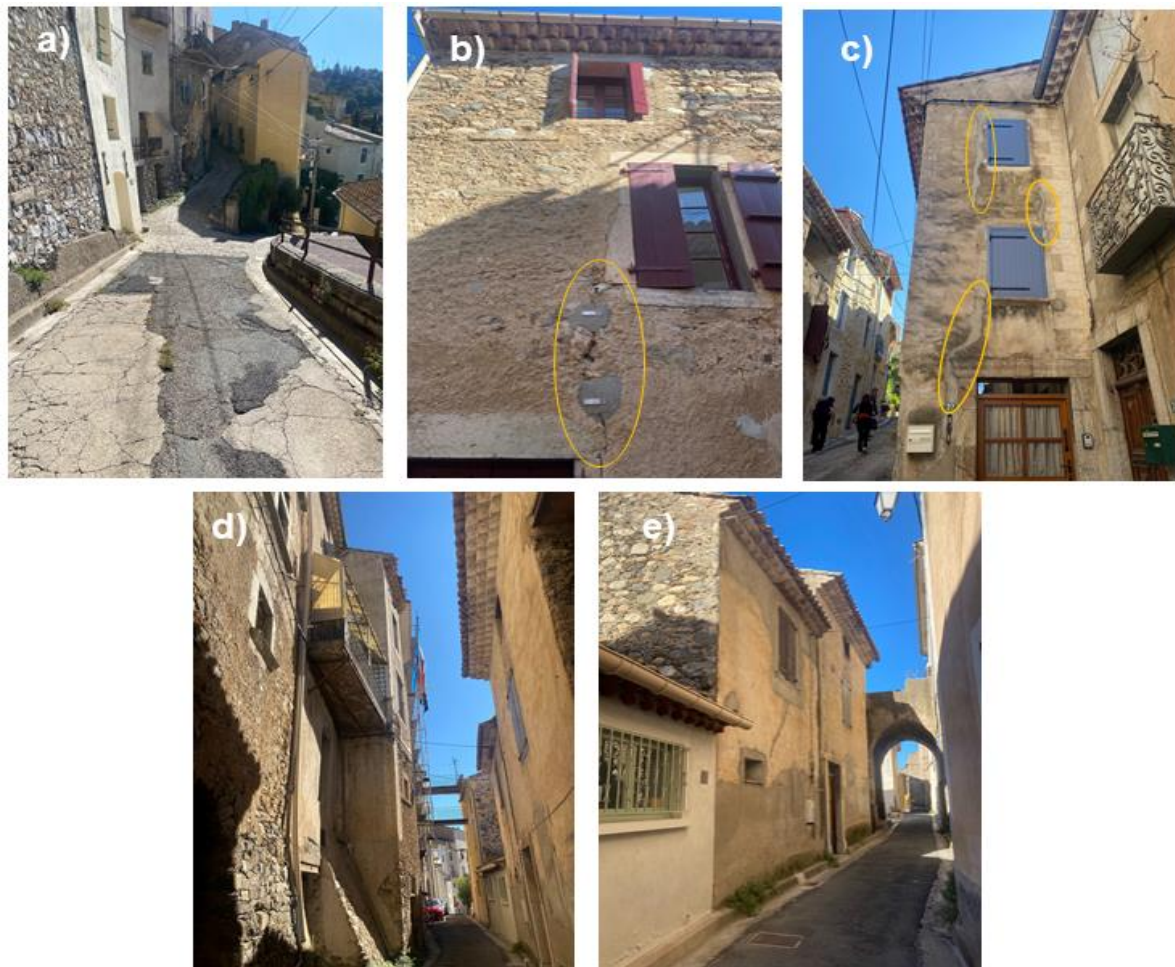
a) chaussée fissurée de la rue sous les fenêtres, b) fissuromètre au n°38 Rue du Barry, c) fissures rebouché rue du Barry, d) vue des bâtiments rue sous les fenêtres, e) fissures rebouchés façade du n°13 rue sous les fenêtres.
